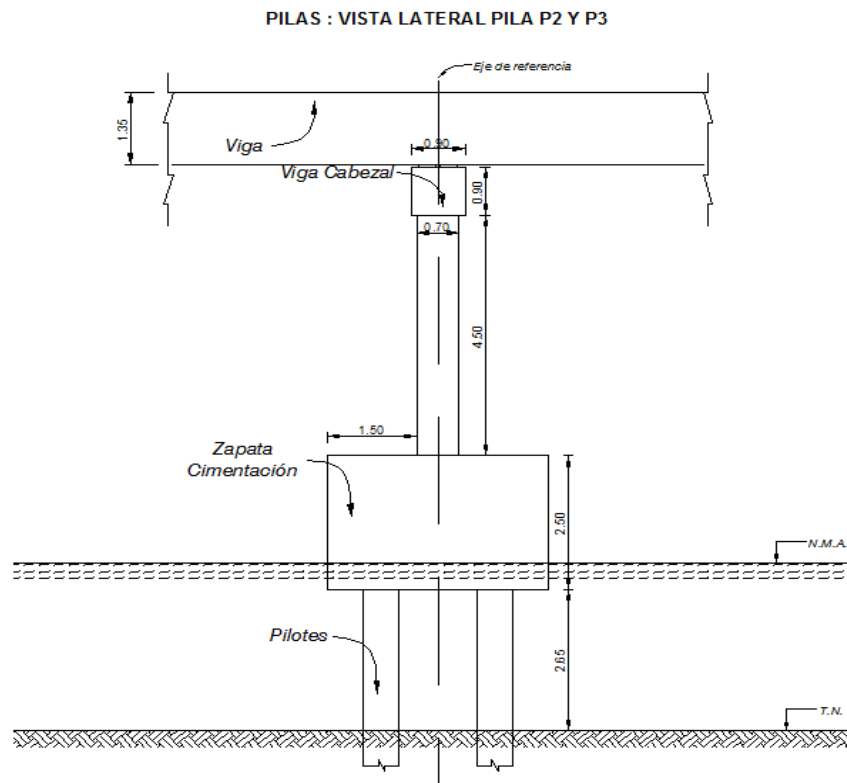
Vista lateral pilas P2 y P3 del puente de Tarifa.
